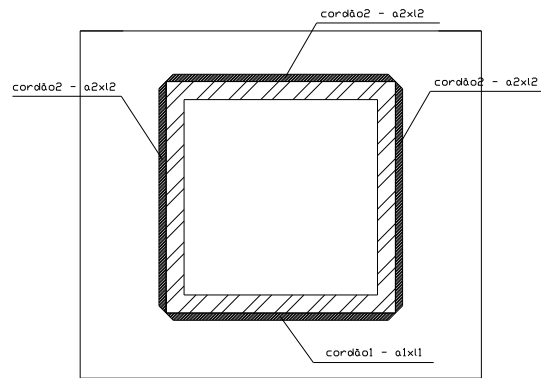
Ligação soldada entre a chapa e o perfilado do banzo inferior
